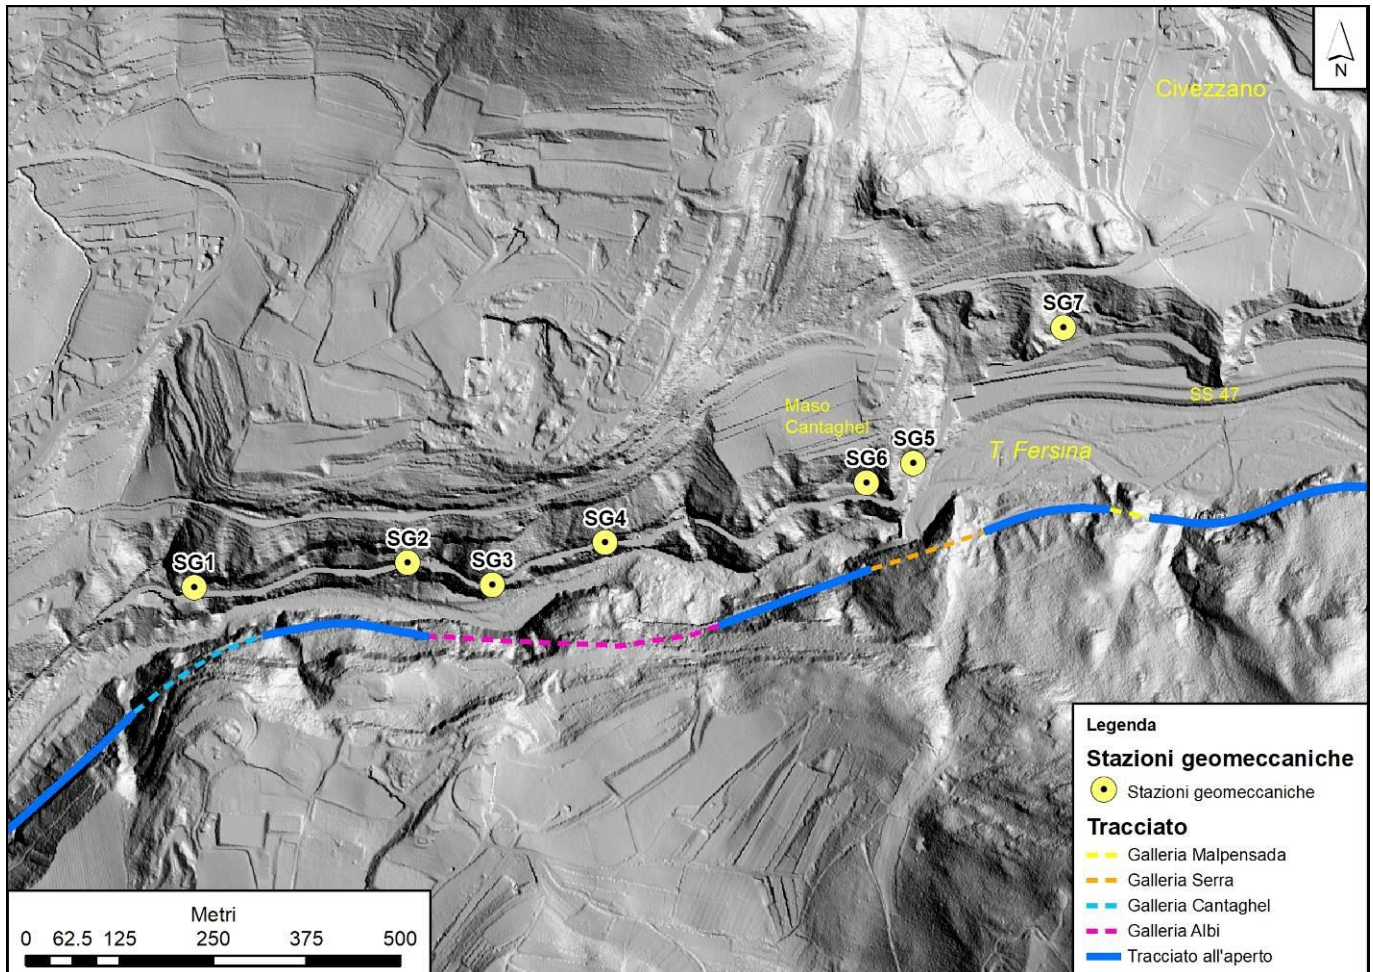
Planimetria ubicazione stazioni geomeccaniche
